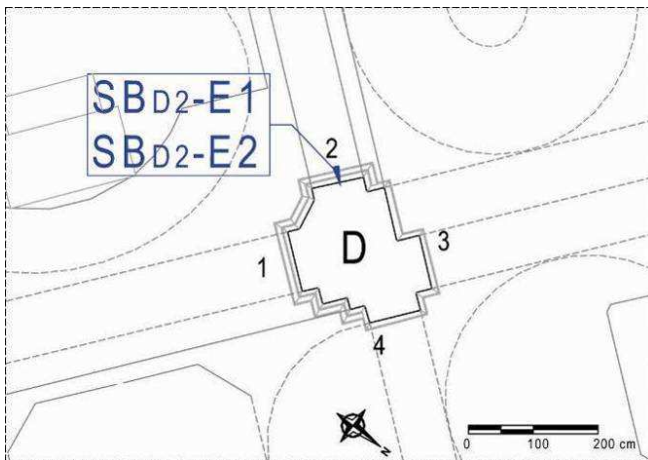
Localizzazione delle prove sul pilastro D.
